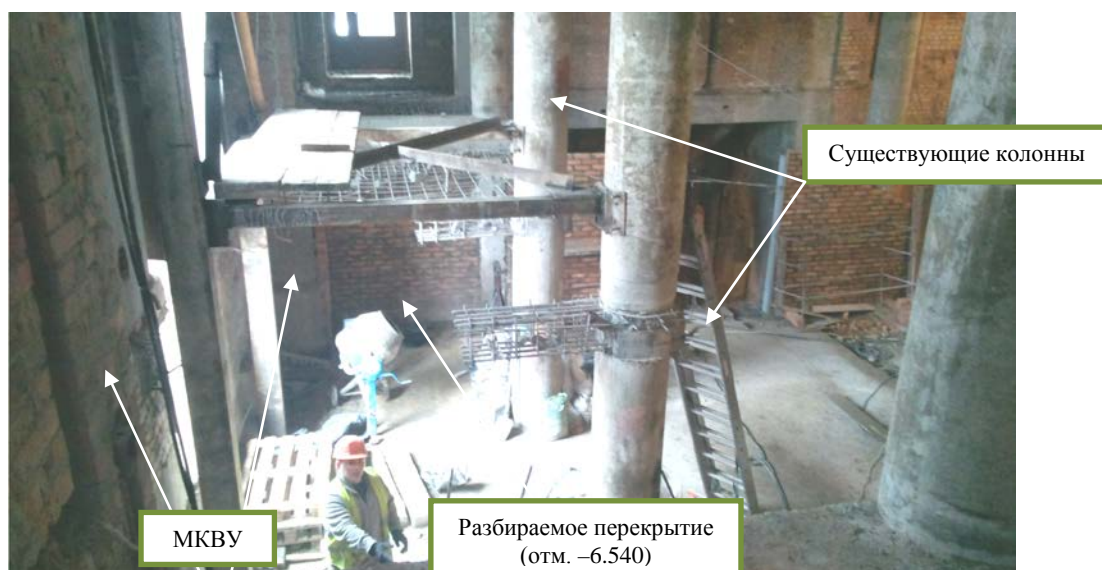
Устройство металлической конструкции временного усиления перекрытия
